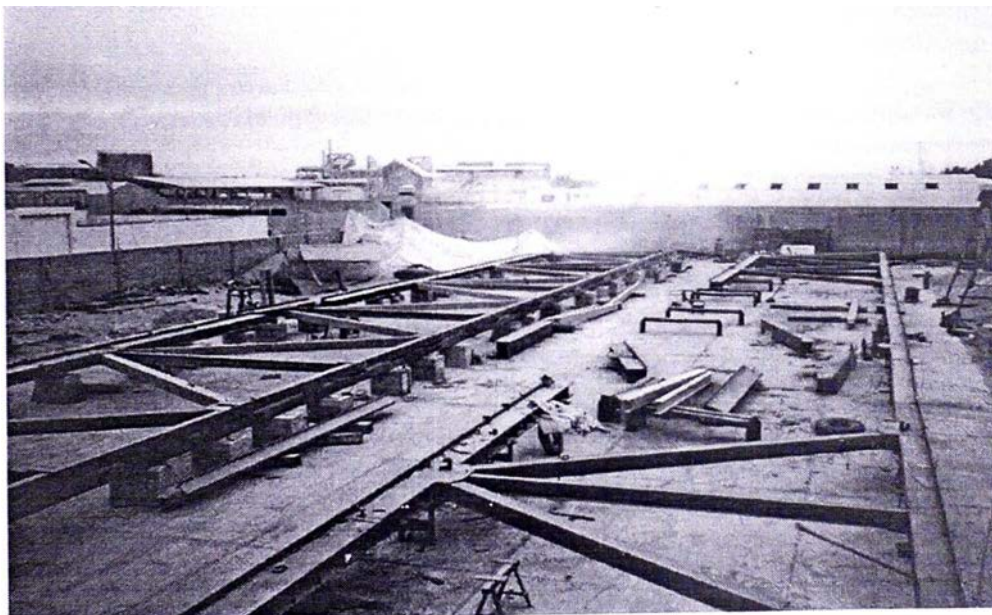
Ensamblaje Horizontal de Armaduras Reticuladas
